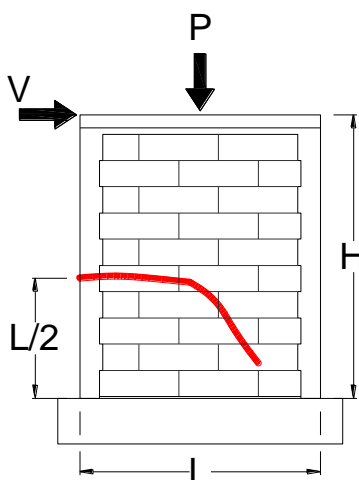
Grieta de flexo-cortante en un muro confinado
